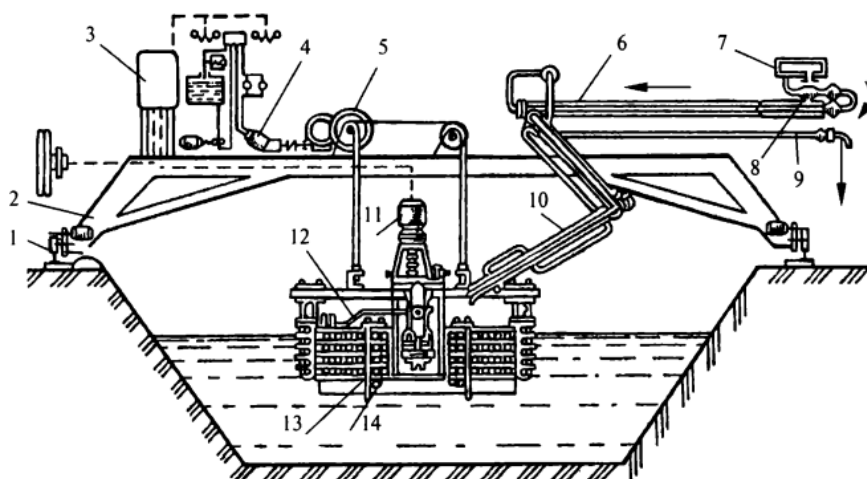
Нагревательно-перекачивающий агрегат:
